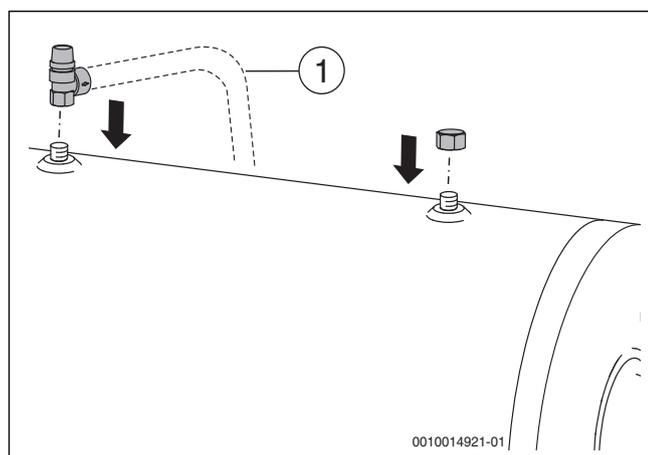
Montaggio della valvola di sicurezza e del tappo
